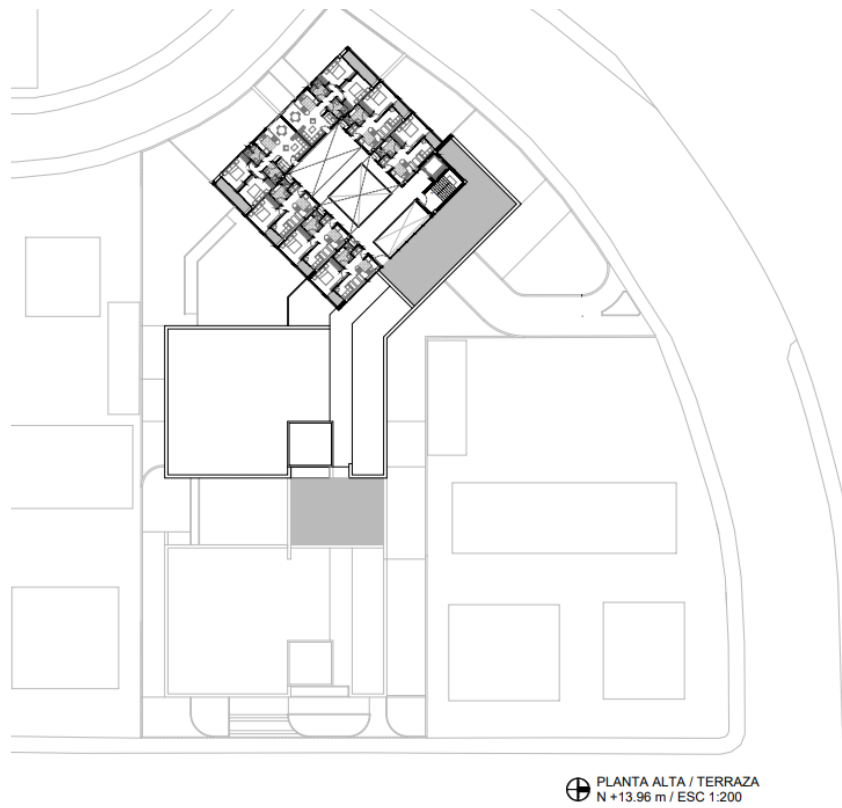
Planimetría: Planta Alta / Terraza (N +13.96 m)
